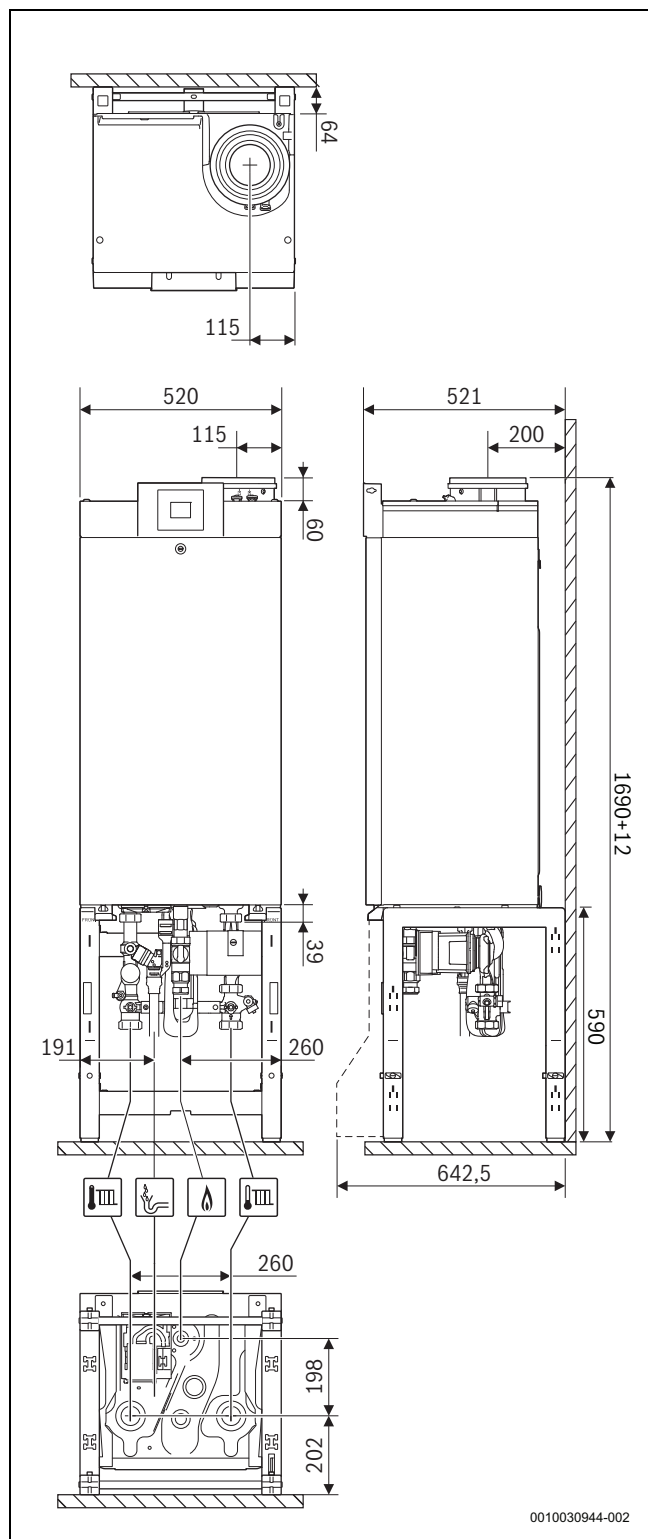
Dimensiuni pe cadrul de bază [mm]
